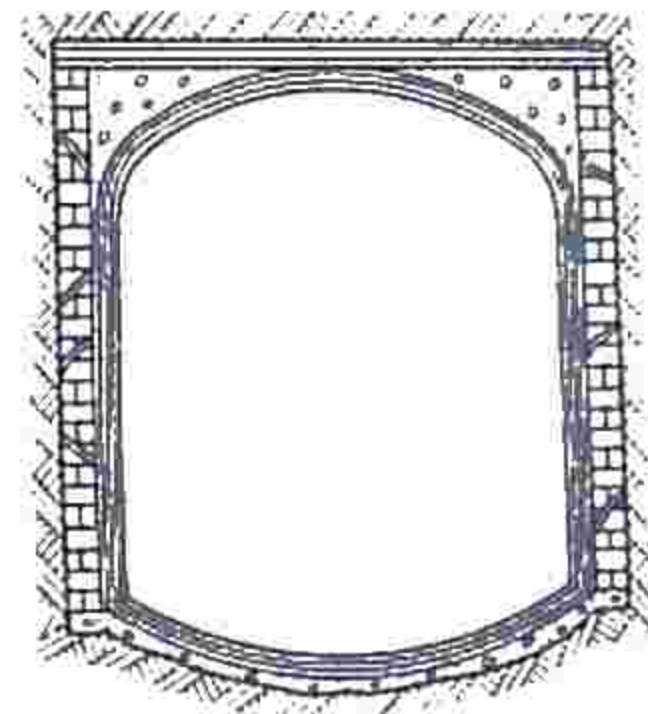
Усиление деформированной крепи металлическими жесткими арками с обратным сводом
